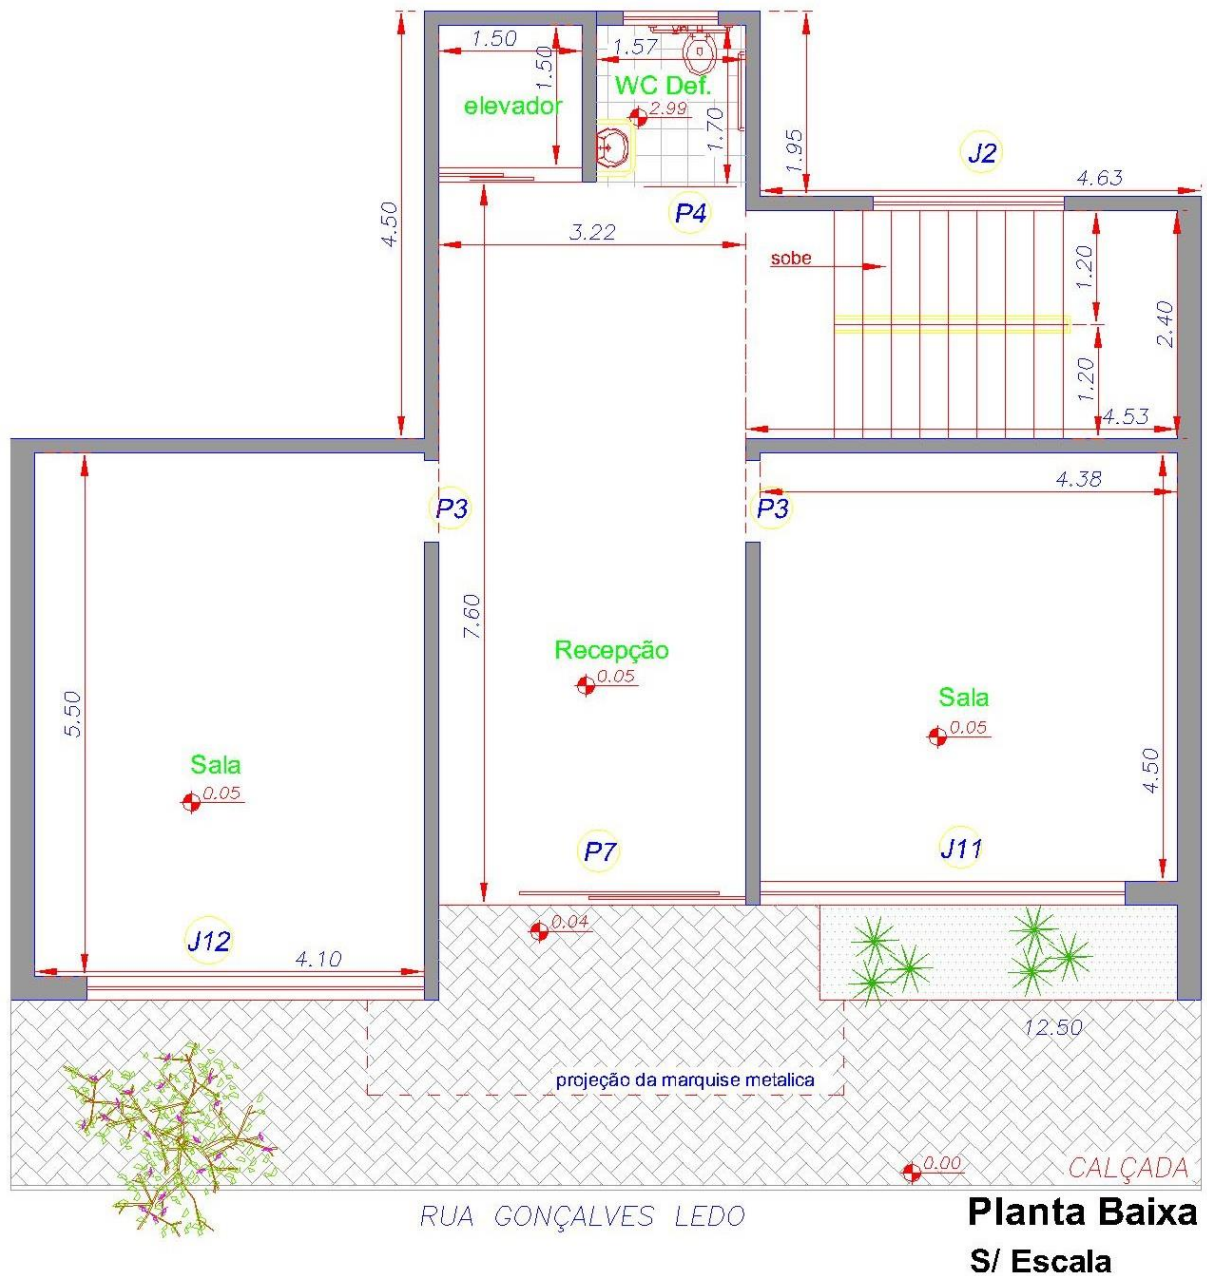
Planta baixa de pavimento térreo. Fonte: autores.
